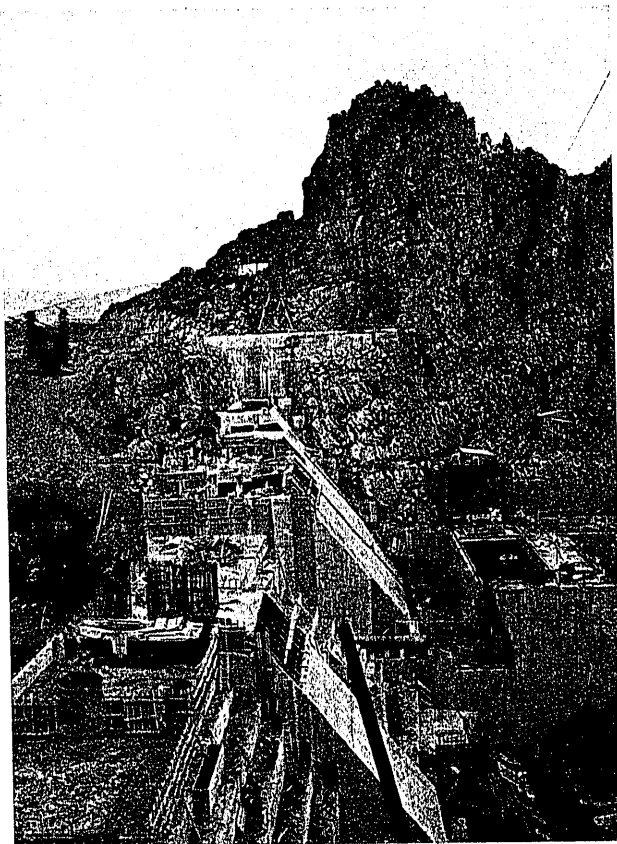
Pantano García de Sola. Aspecto de la presa, ya muy avanzada la construcción. Las cuarcitas constituyen el terreno de esta zona.
